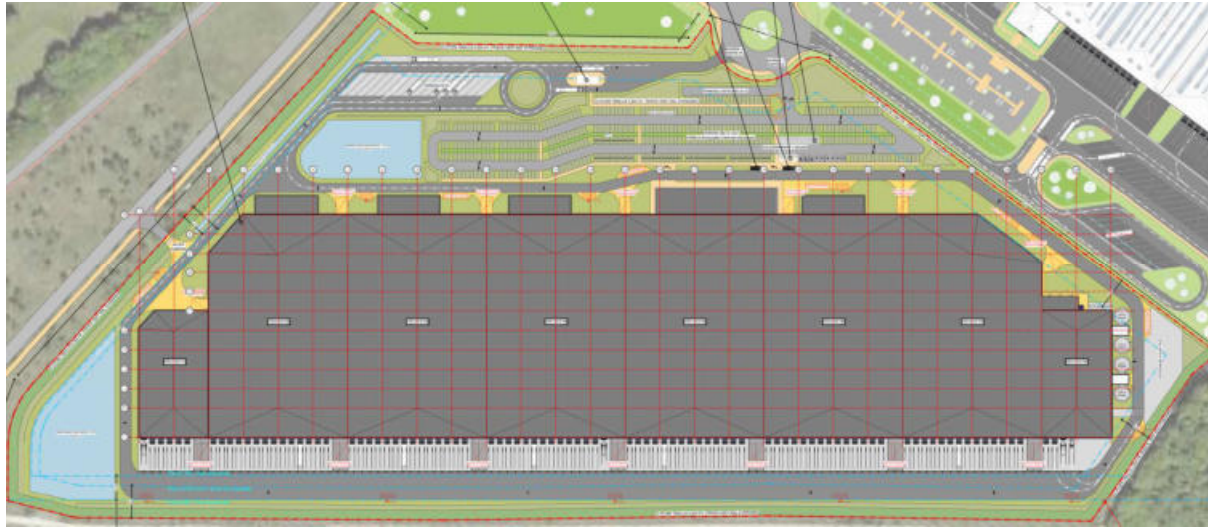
Plan de masse (Source : ARCHI-FACTORY)
